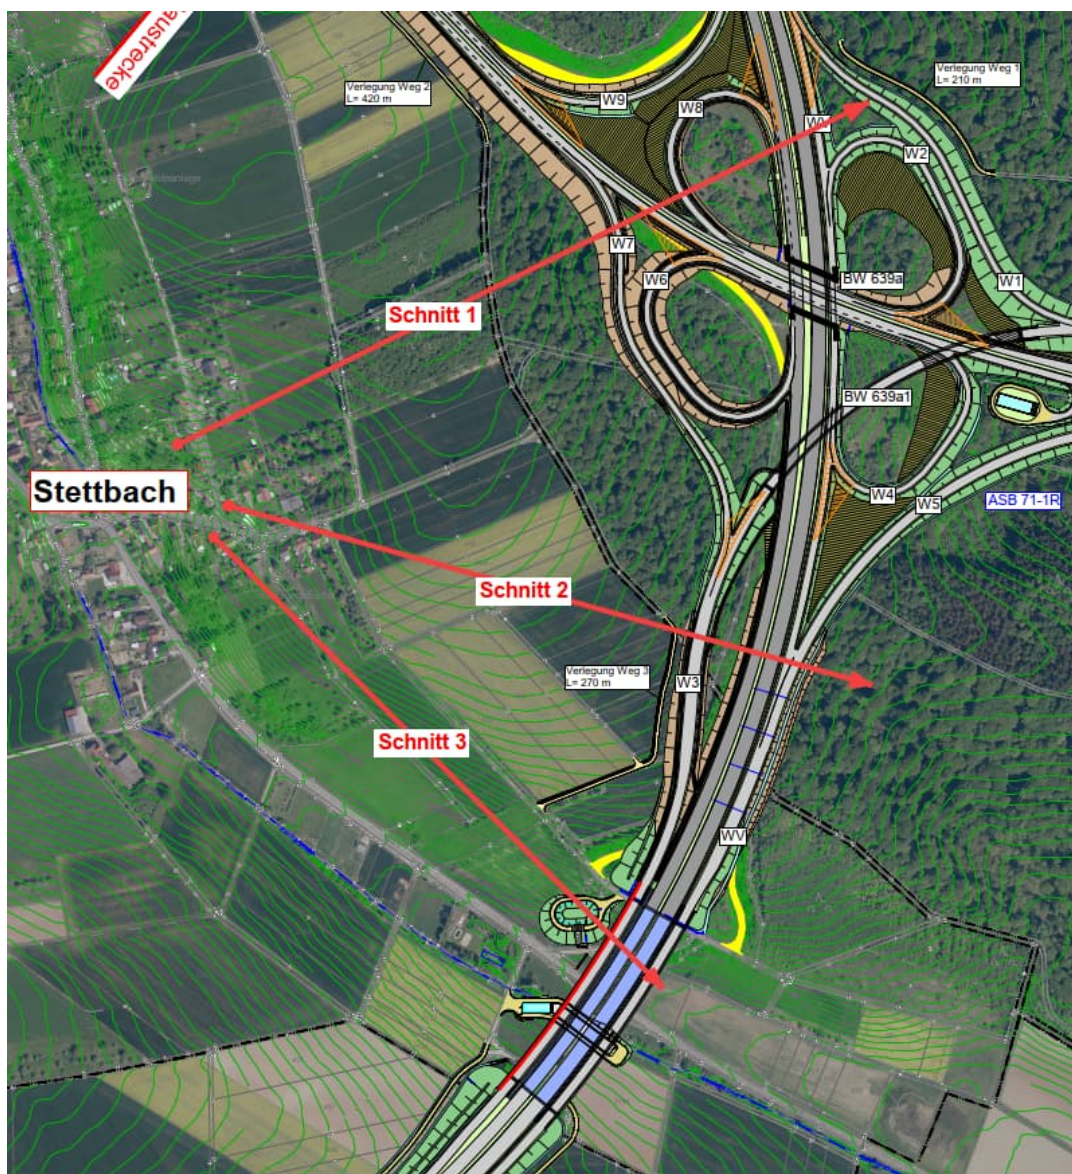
Lageplanauszug mit Lage der Schnitte - Stettbach
